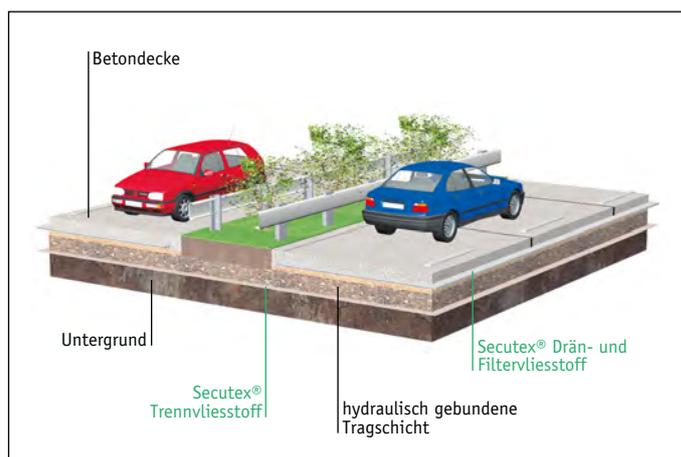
Entwässerung unterhalb einer Betonstraßendecke mit Secutex® Dränvliesstoff
